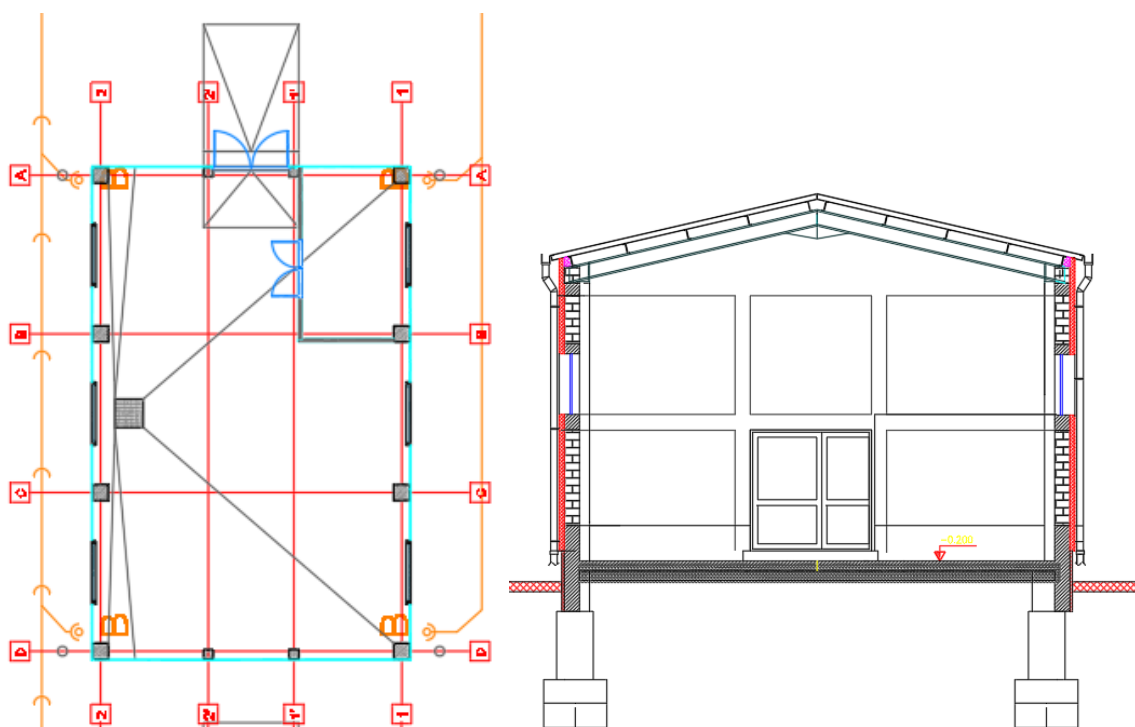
Pianta e sezione magazzino prodotti chimici
